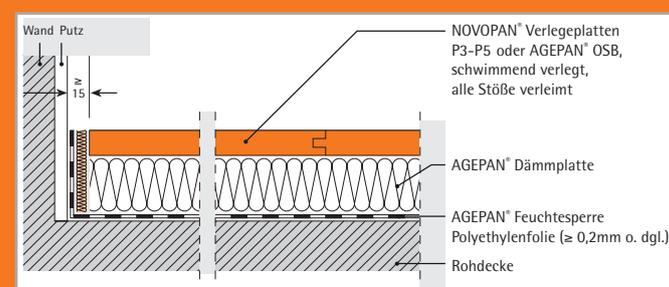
Das schwimmende Verlegen auf Decken mit AGEPAN® Dämmplatten.
